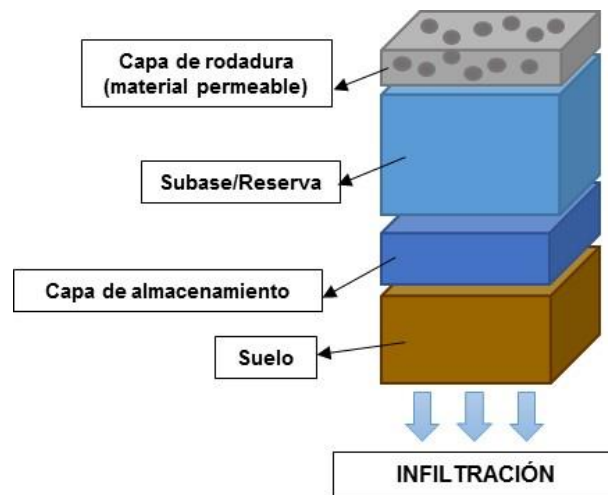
Esquema general de sección transversal de un pavimento permeable donde se aprecia la configuración multicapa de ésta. Fuente propia.
